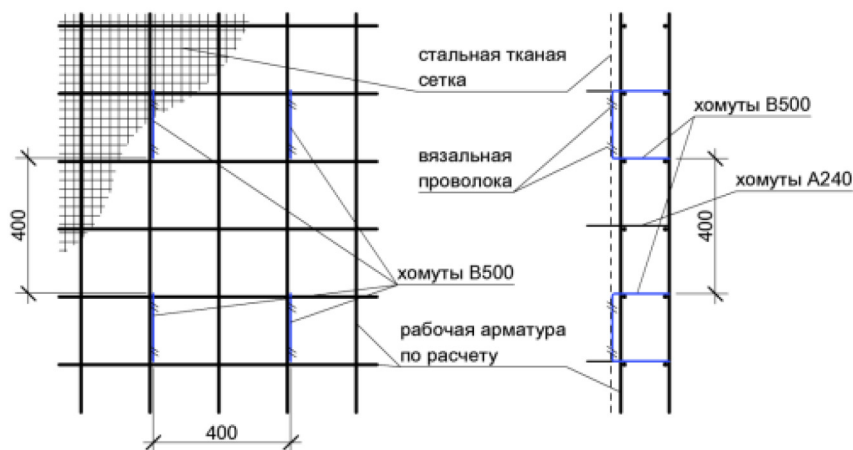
Схема крепления металлической разделительной сетки к арматурному каркасу
